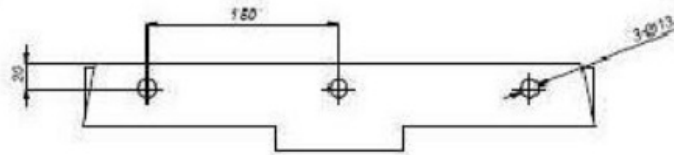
Desain Precast Fondasi (samping dalam)
